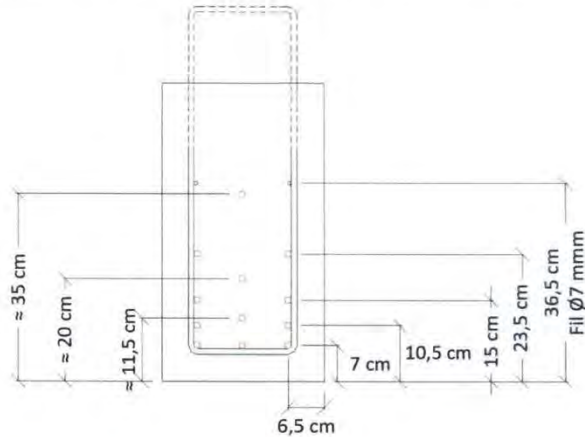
Ferrailage des poutres (Extrait du rapport du LERM)
